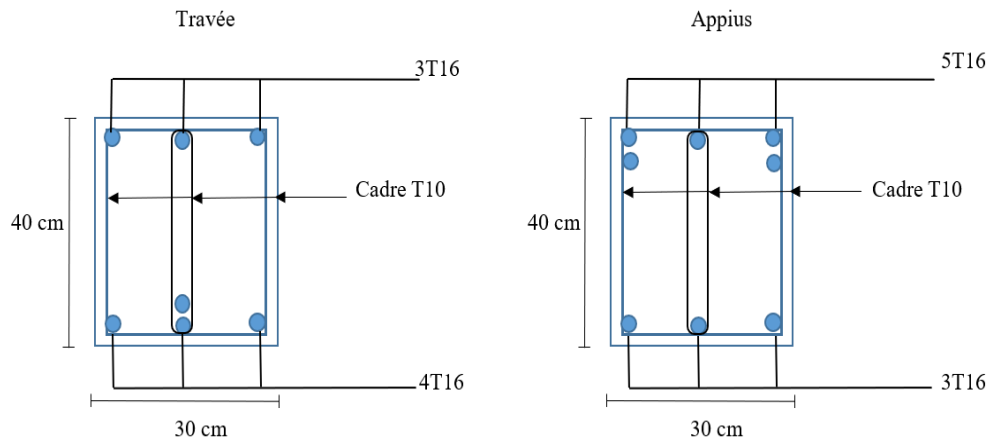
Ferrailage du plancher courant de la poutre secondaire avec voile.
